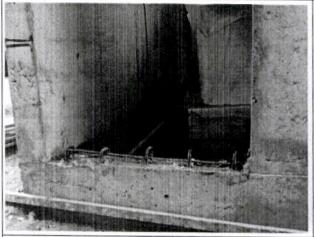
Nido de piedras en muro interior de vivienda B-504.
